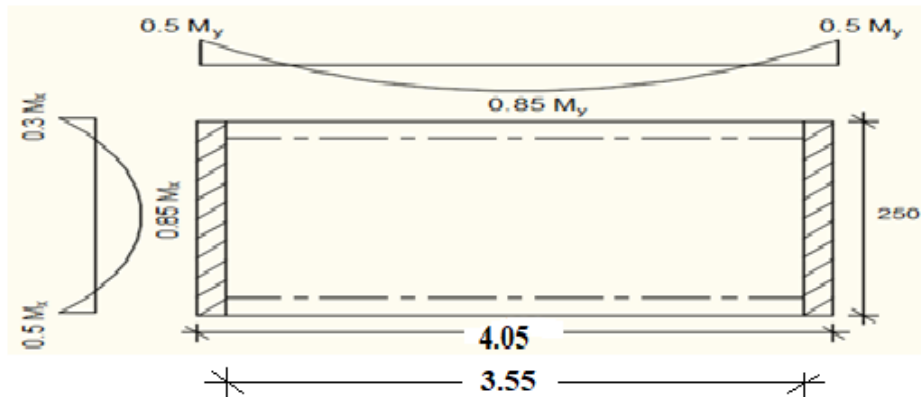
Schéma du panneau de la dalle appuie sur 4 coté.
